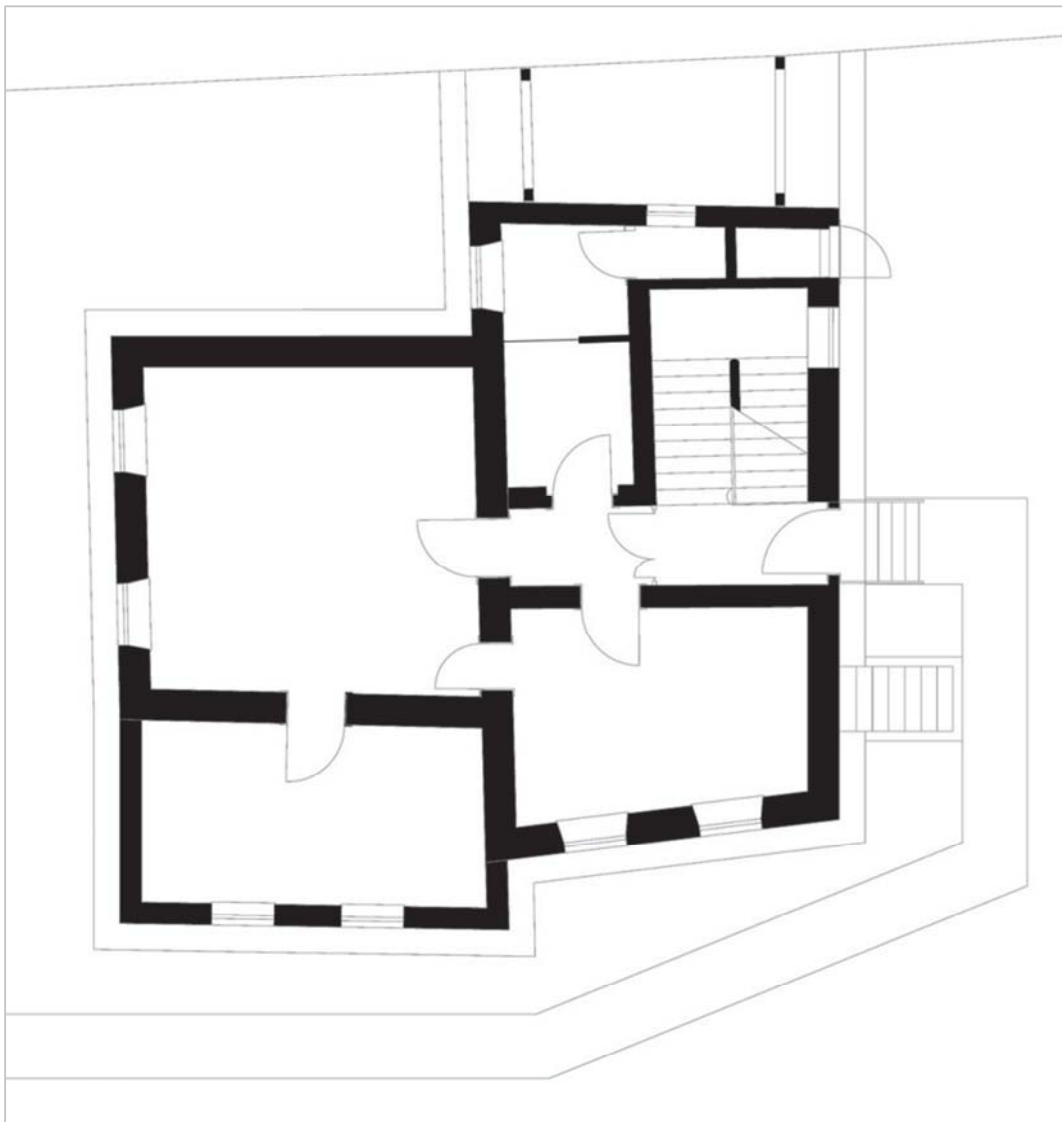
Grundriss Erdgeschoß, 2017
